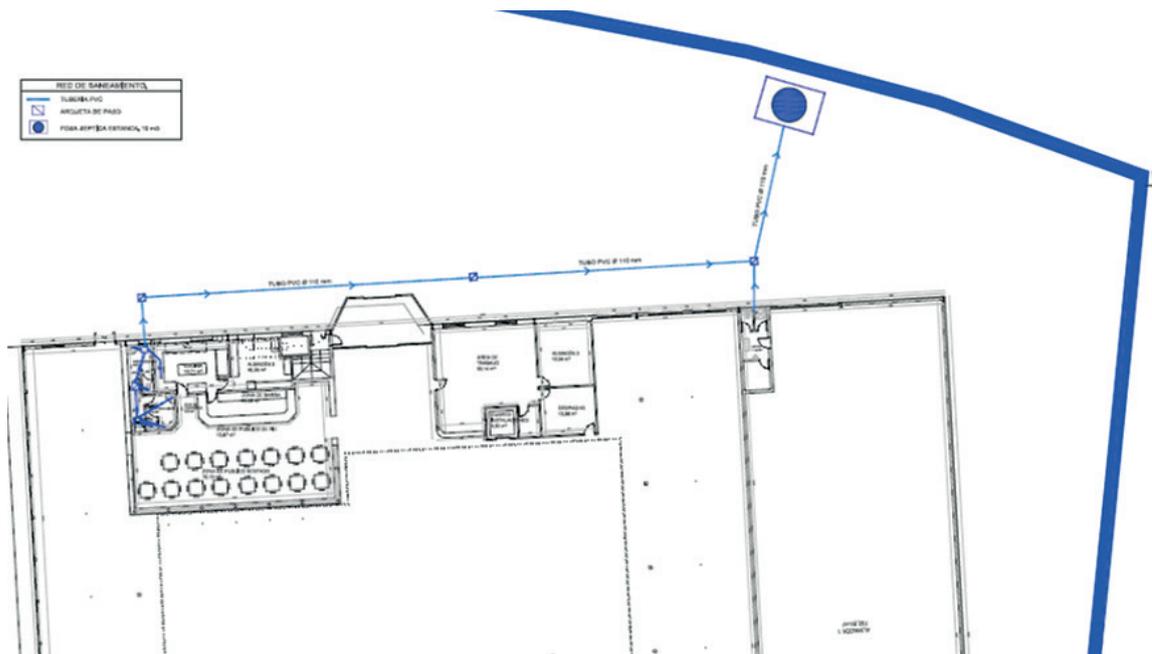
Plano rede saneamiento de nave de exposición y restauración
